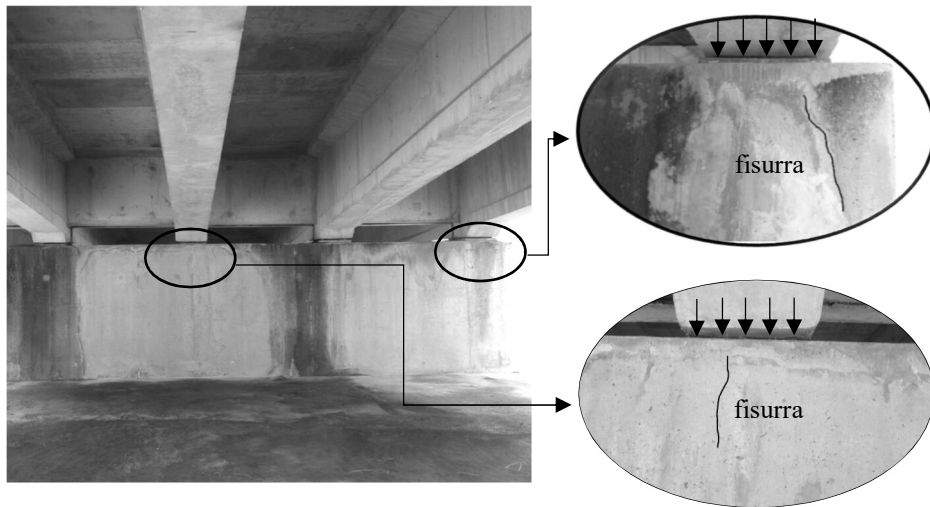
Fissuras de fendilhamento em uma ponte localizada no município de Tucuruí - PA
